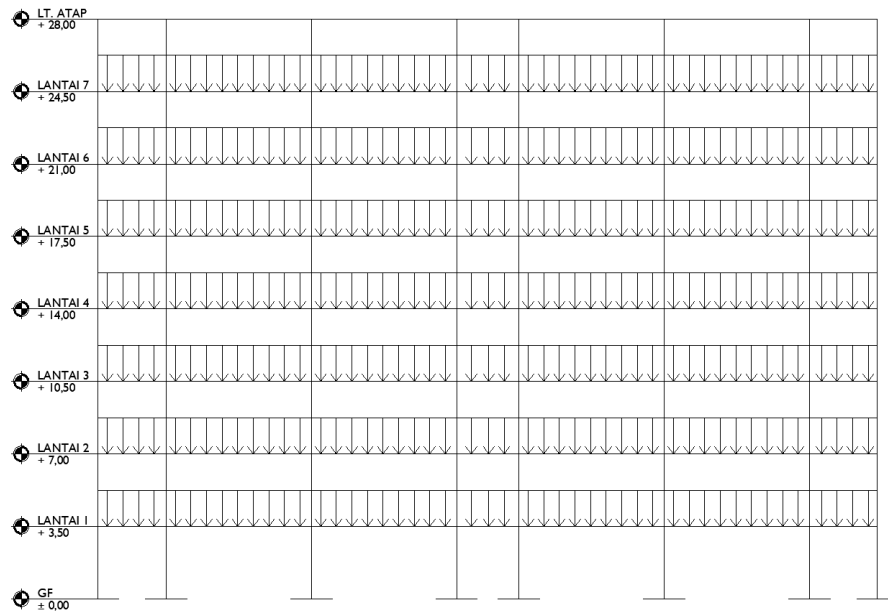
Denah Potongan Beban Portal As C Arah X
